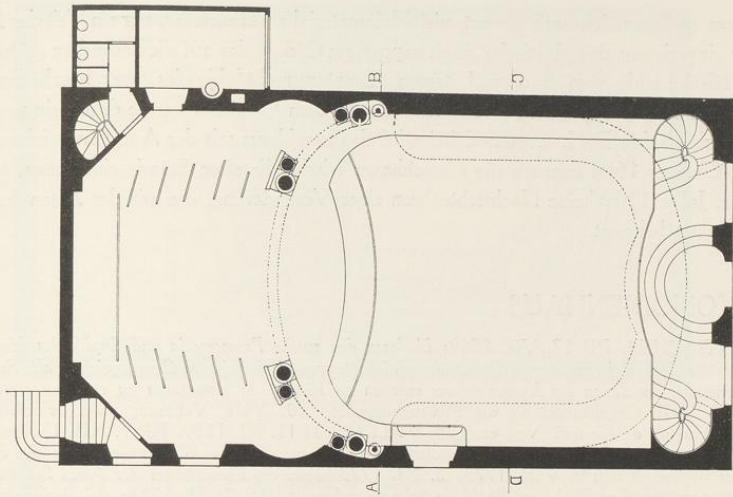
Grundriß des Erdgeschosses des Theaters
